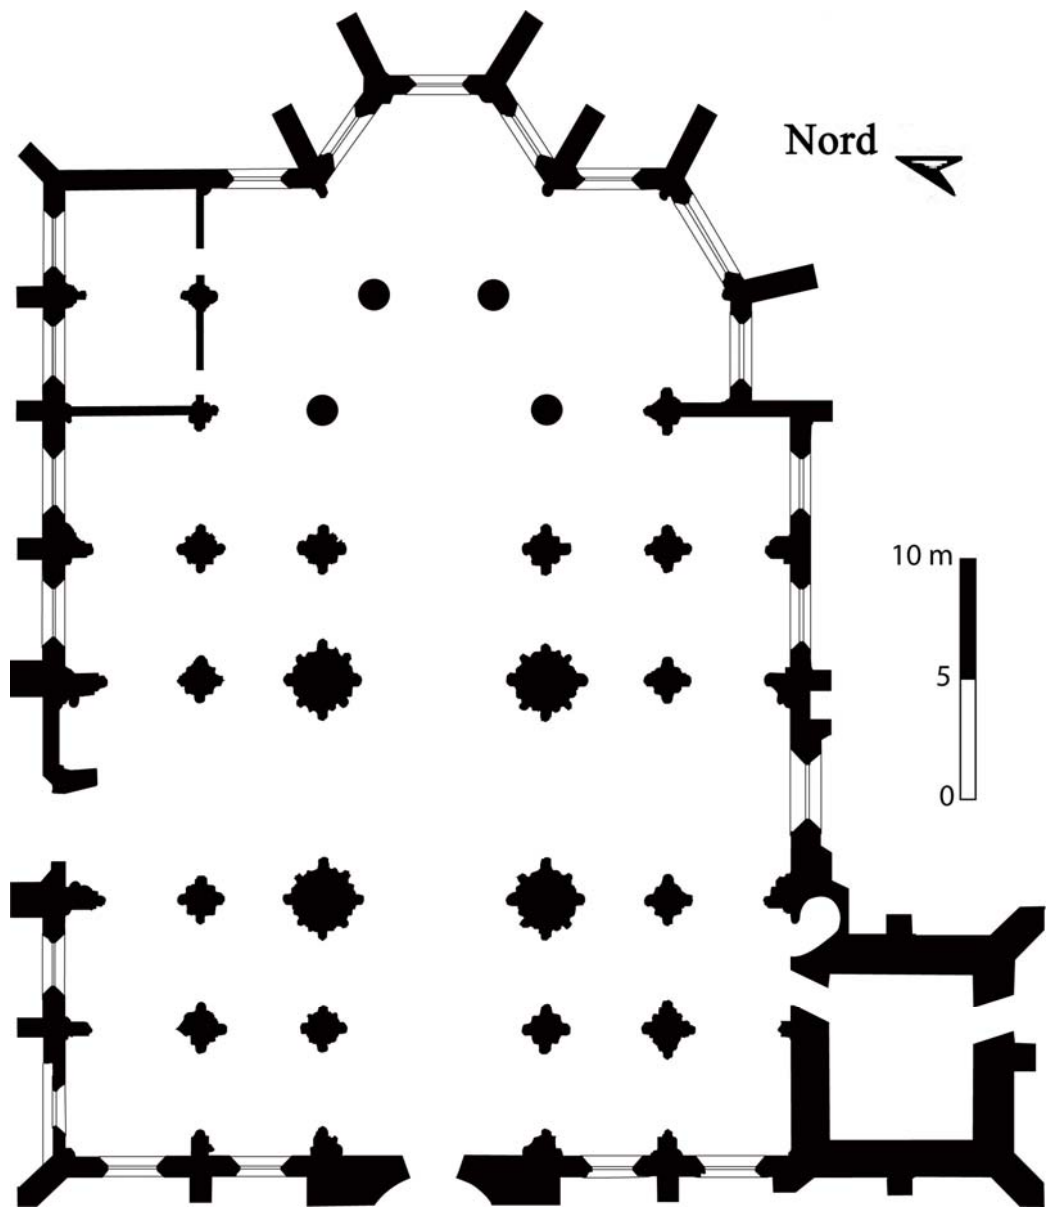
Plan de l'église Sainte-Madeleine de Troyes d'après un plan du S.D.A.P. de l'Aube.
